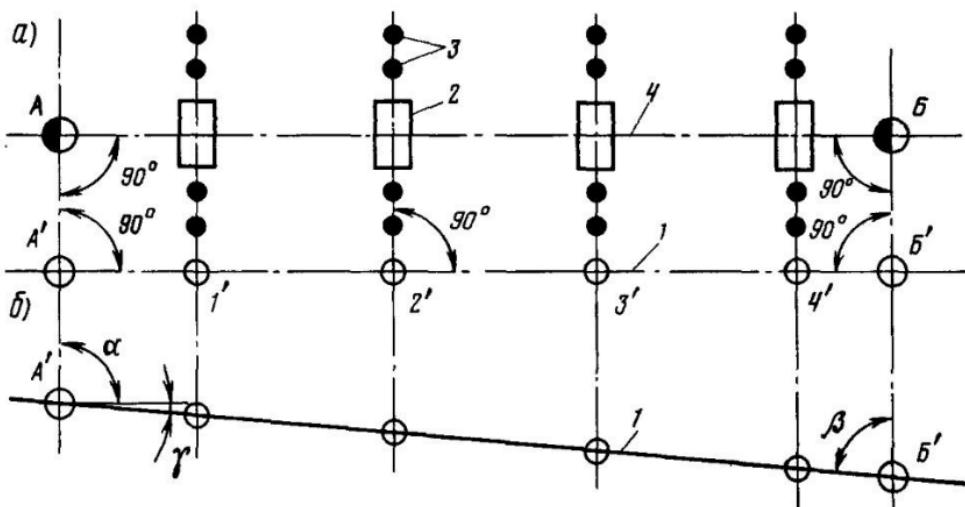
Схема разбивки фундаментов опор с подмостей:
